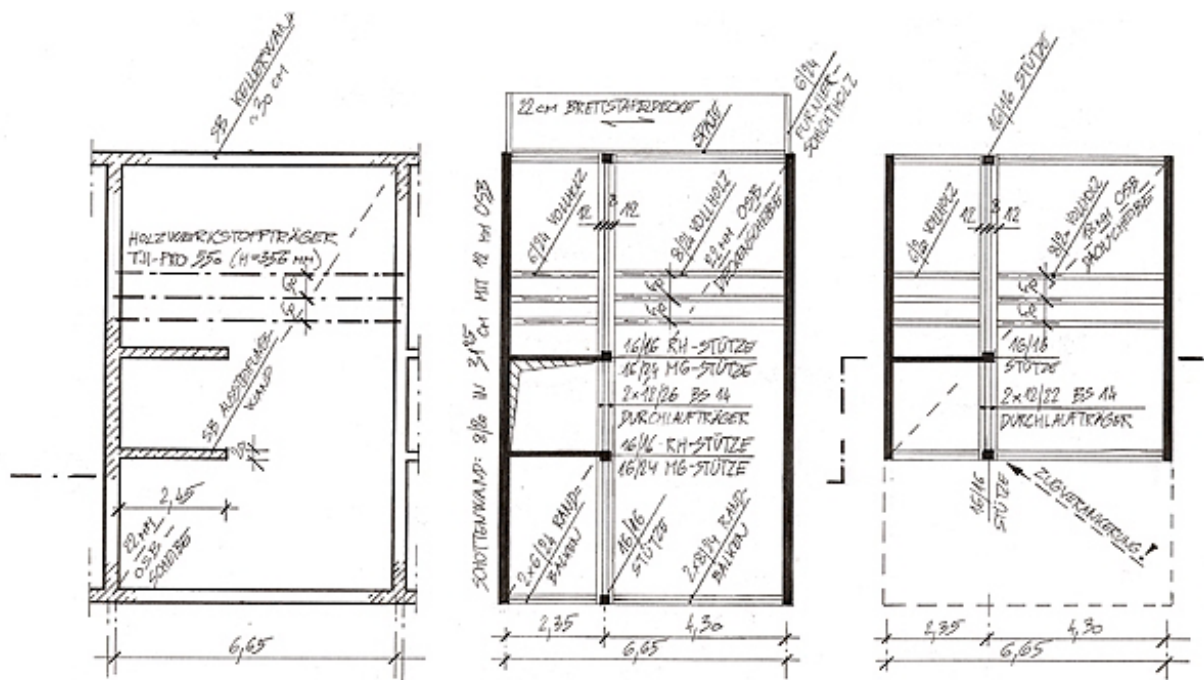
Grundrisse vom Tragwerk Reihenhaus-schmal und Mehrgeschosser Kellerdecke, Zwischendecke und Dach, innere Stützenquerschnitte müssen bei Mehrgeschosser erhöht werden
